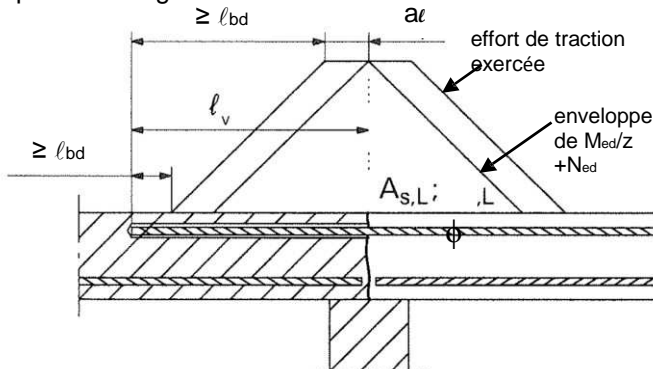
Ancrage en extrémité de dalles ou poutres (ex. conçu comme simplement appuyé)
